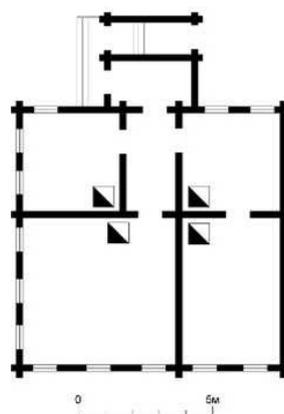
План 1 этажа каменного дома из состава усадьбы Миншутиных [2]
